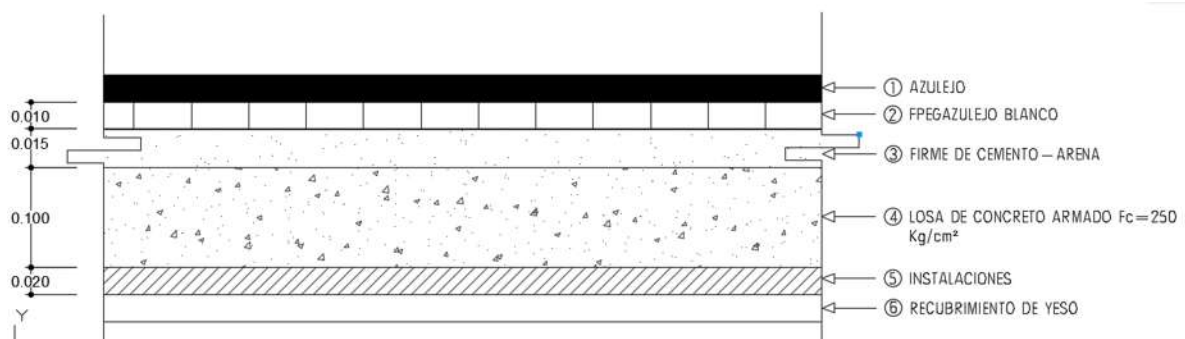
detalles de los espesores de la losa horizontal del primer nivel
